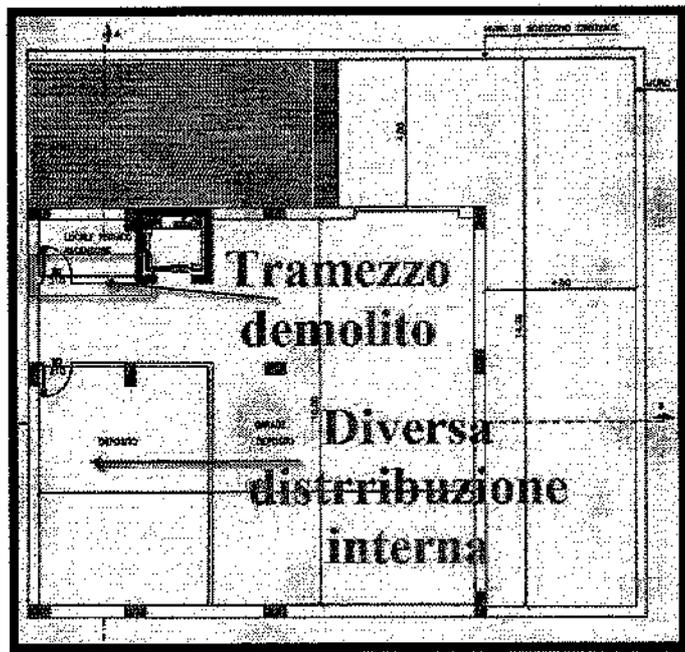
Pianta piano Seminterrato allegata alla D.I.A. prot. 1461 del 13/02/2008
